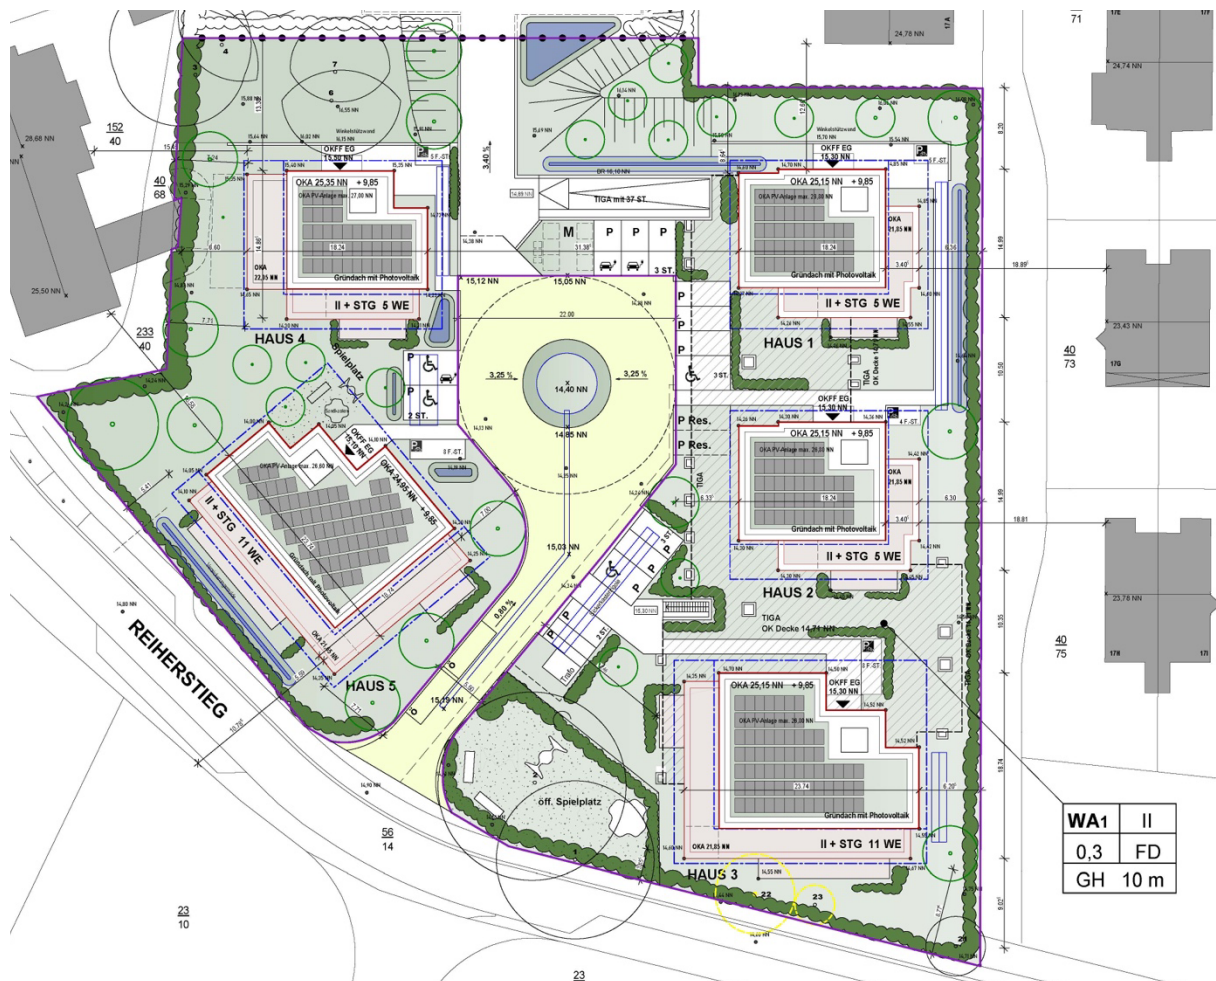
Lageplan Vorhaben (Stand: 11.07.2024)
